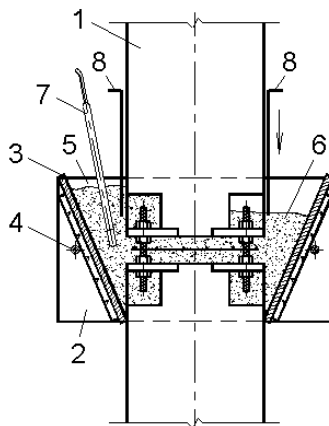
Общий вид бетонирования стыка сборных колонн с винтовыми соединениями
